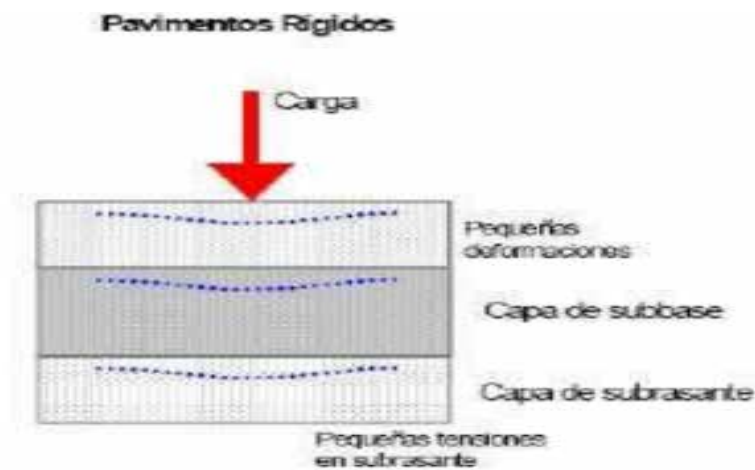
Ejemplo de las Capas del Pavimento Rígido.
